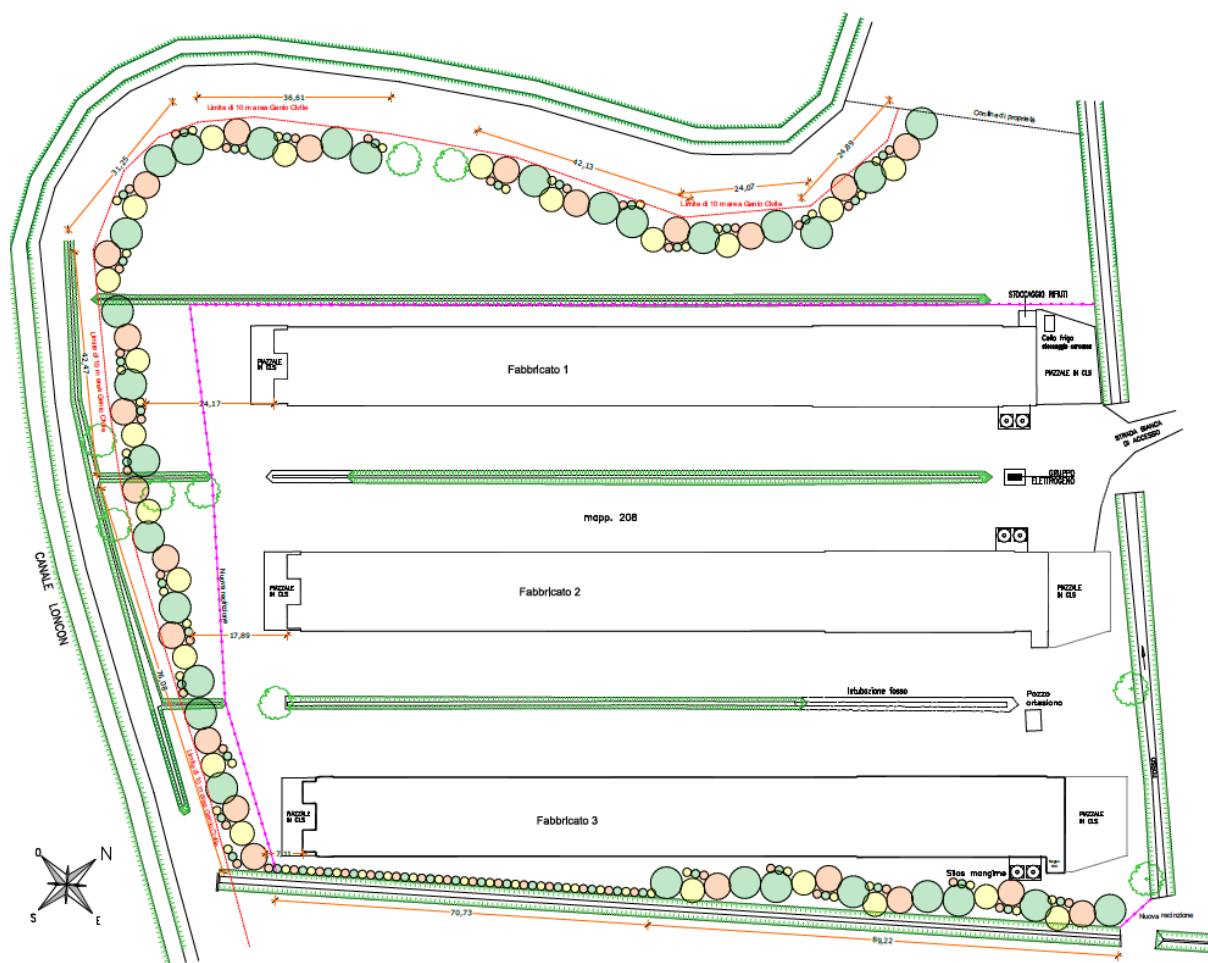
Planimetria dell'impianto con l'intervento di mitigazione ambientale
